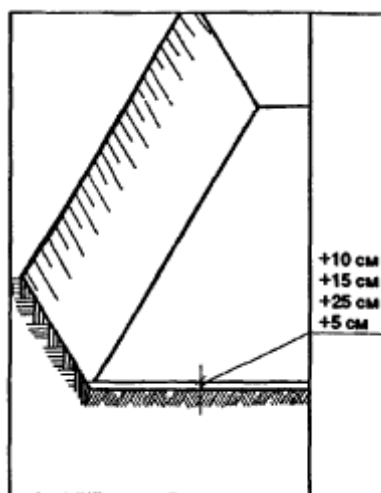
Допускаемые отклонения разработки котлована
